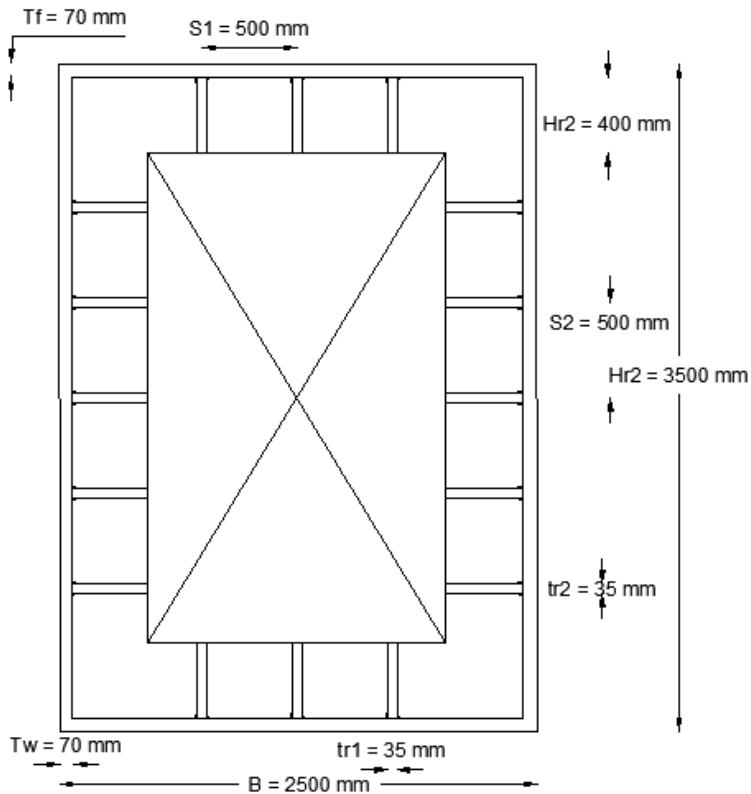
Gambar Sketsa Penampang Box Girder
